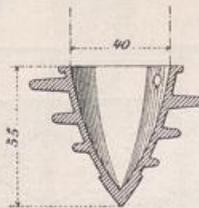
Gußeiserner Schraubenschuh für Holzpfähle. M. 1 : 30.
